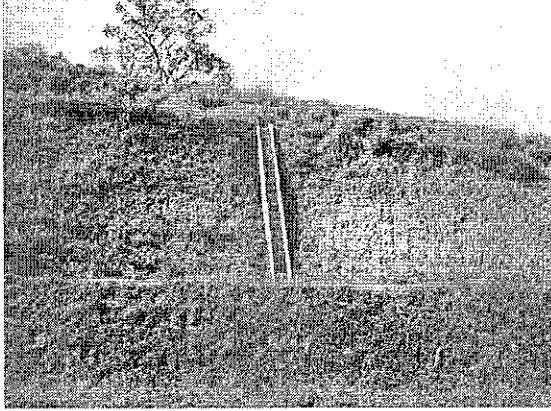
Lote 02/RS - Ponte sobre o Rio Mampituba.
